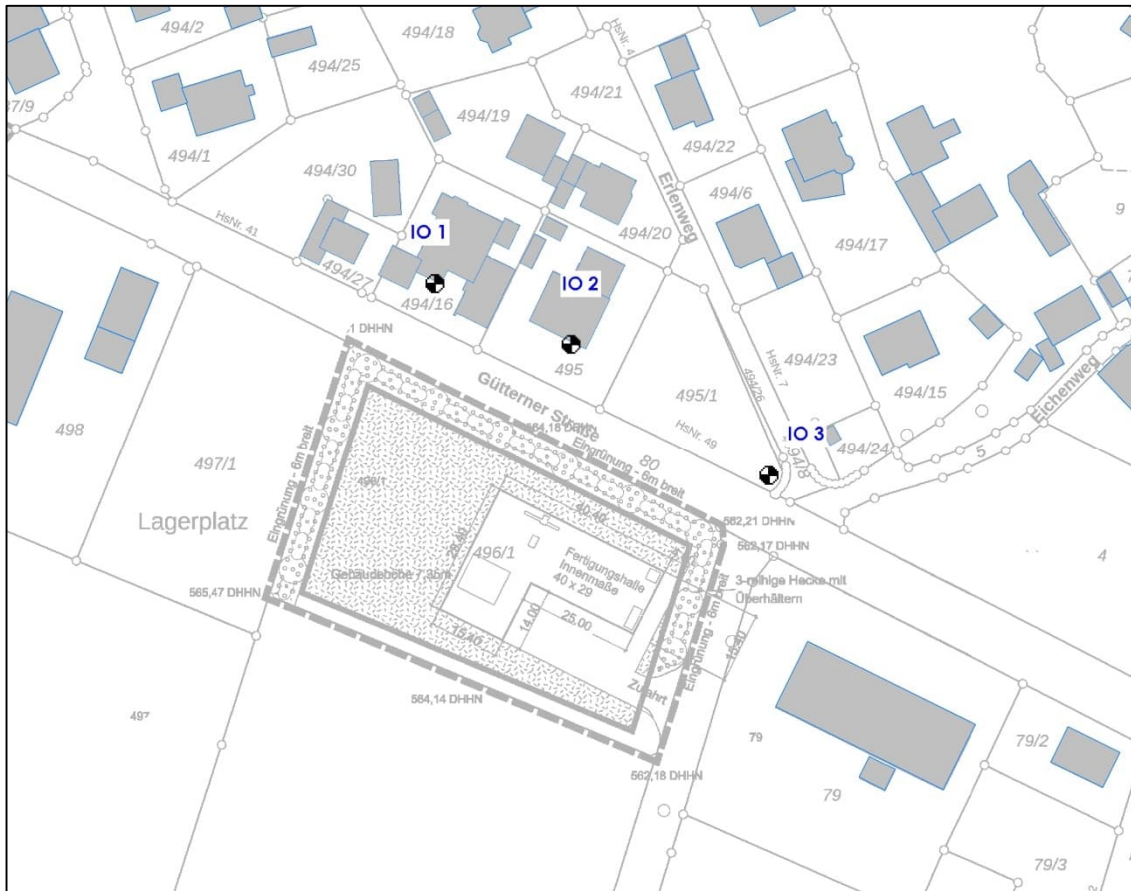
Lageplan mit Darstellung der maßgeblichen Immissionsorte (IO)
